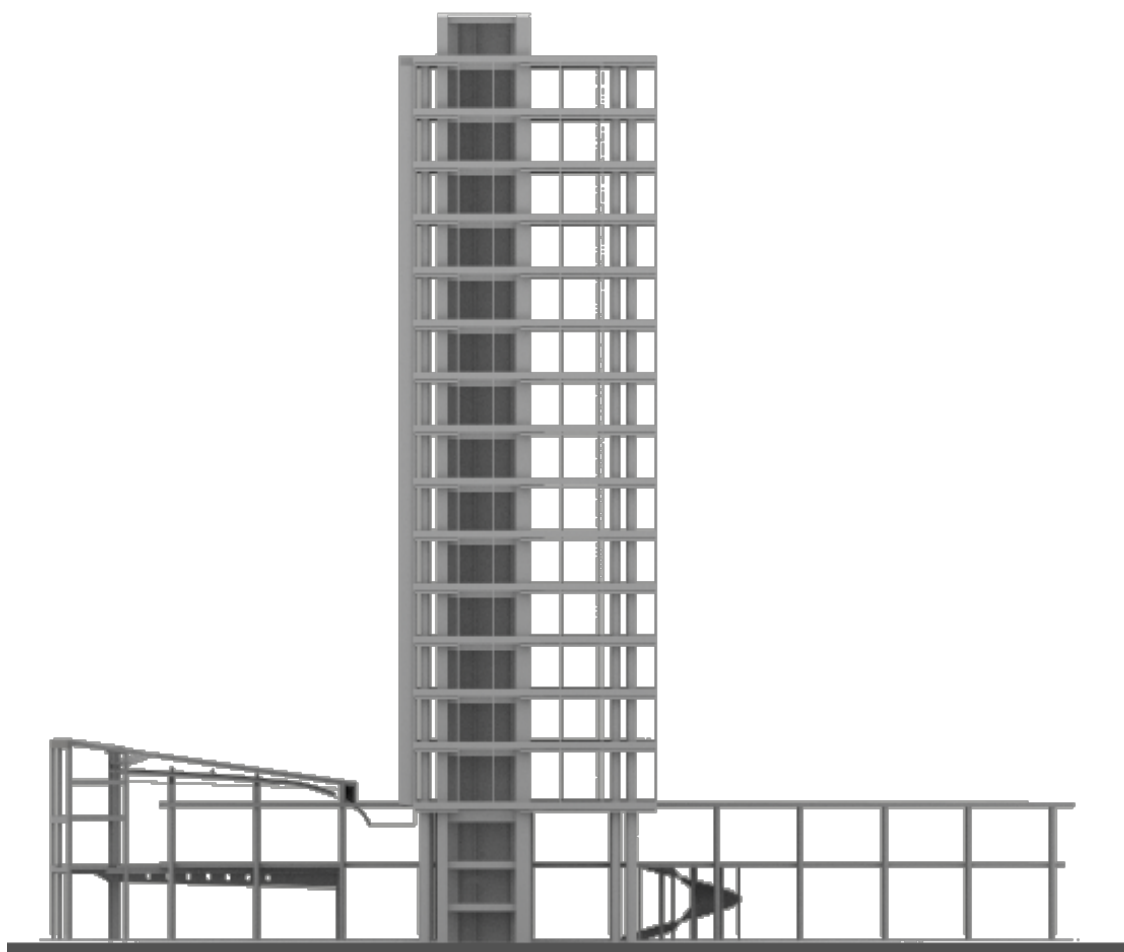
Corte transversal da estrutura. Perspectiva estrutural do MESP. Estrutura em concreto armado do MESP conforme projeto estrutural de Emílio H. Baumgart. Fonte: Autor. 2015.
